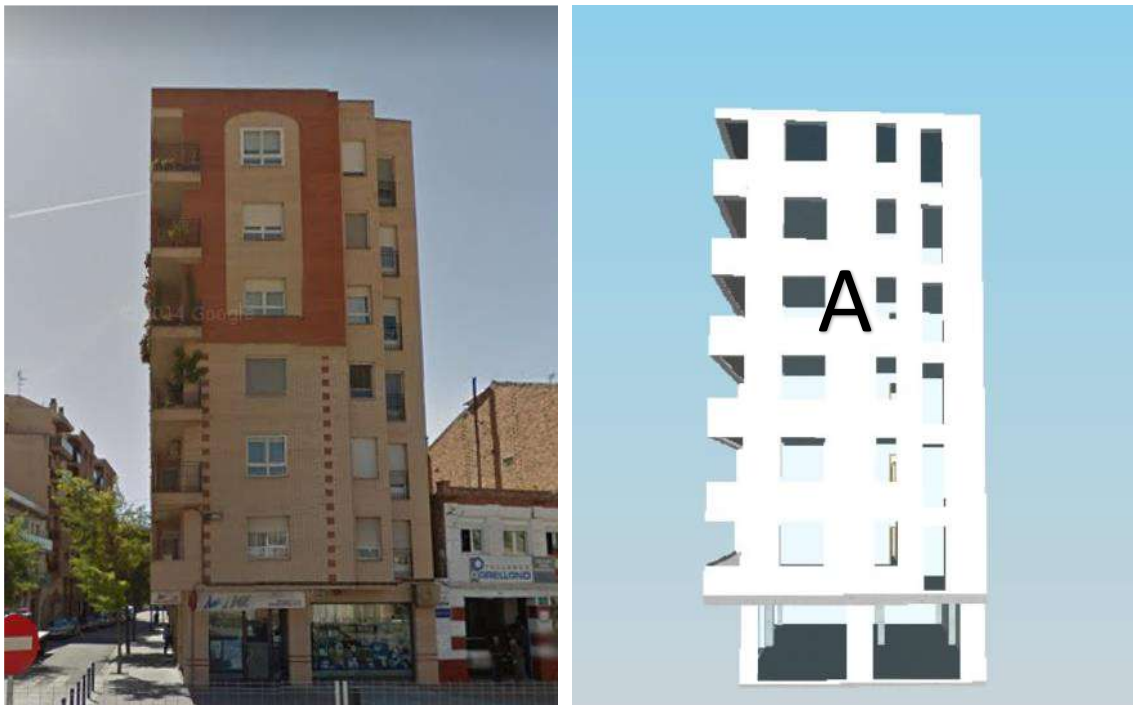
Fachada lateral orientada principalmente hacia el norte.
